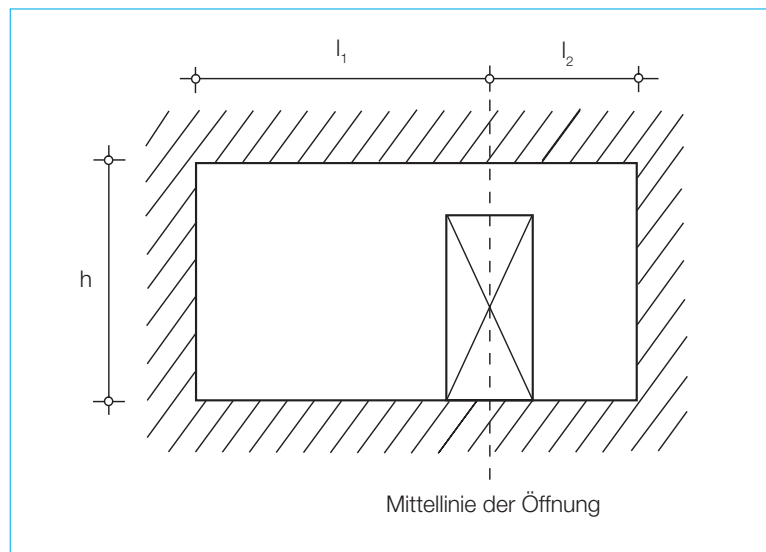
Wandtyp a mit einer Öffnung gemäß DIN EN 1996-3 [4.21.4]
